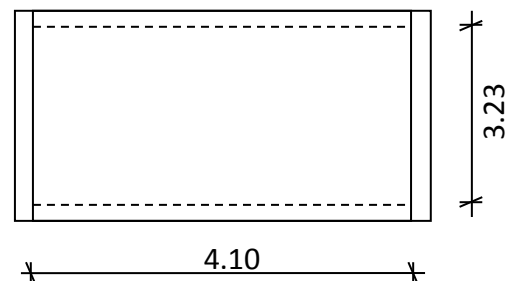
Panneau de dalle appuie sur 4 coté
